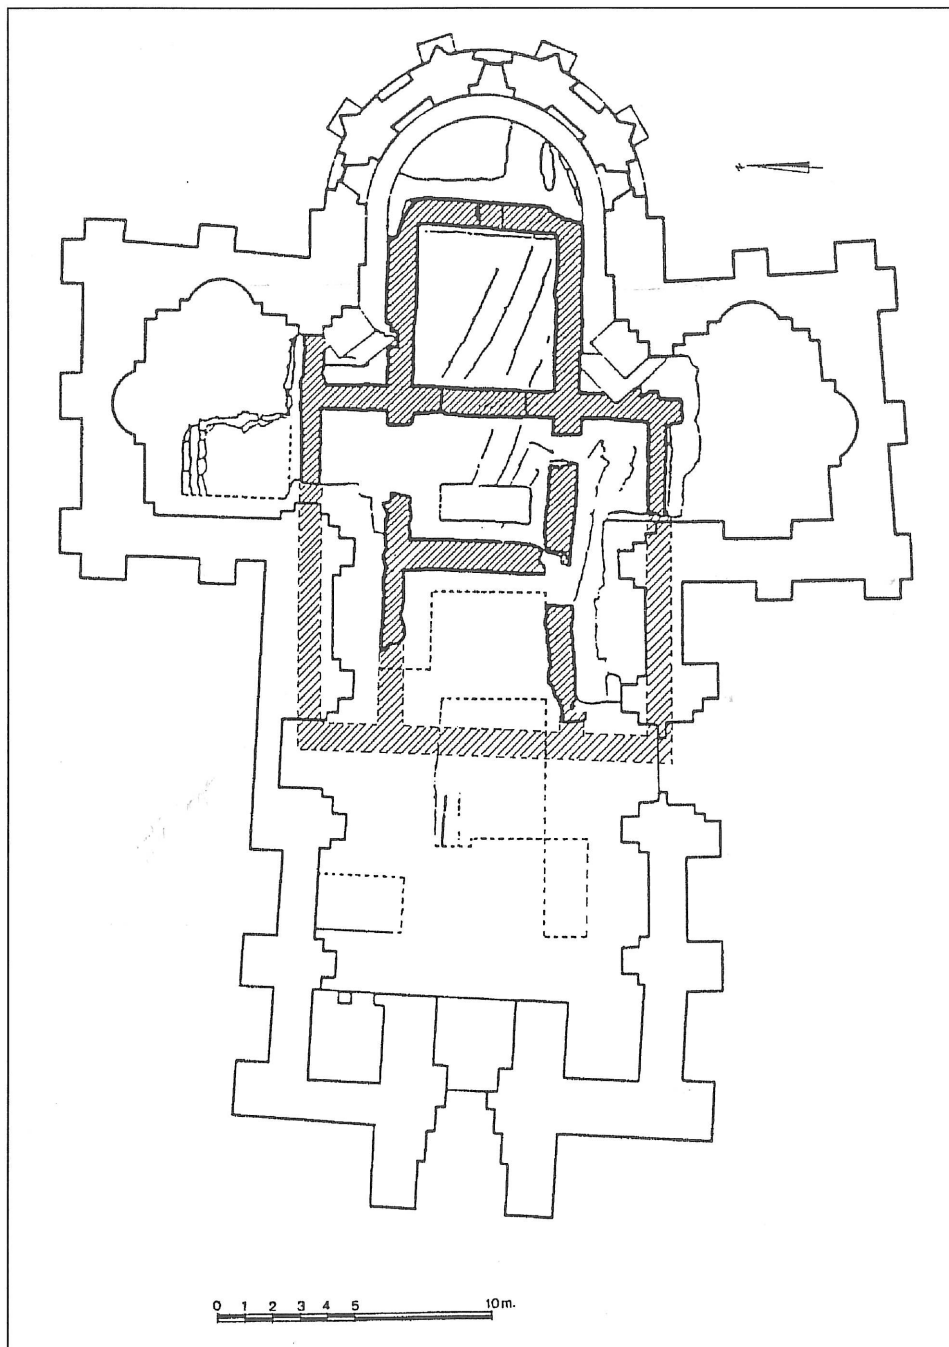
Siresa (Huesca). Planta (según: Puertas Tricas)
